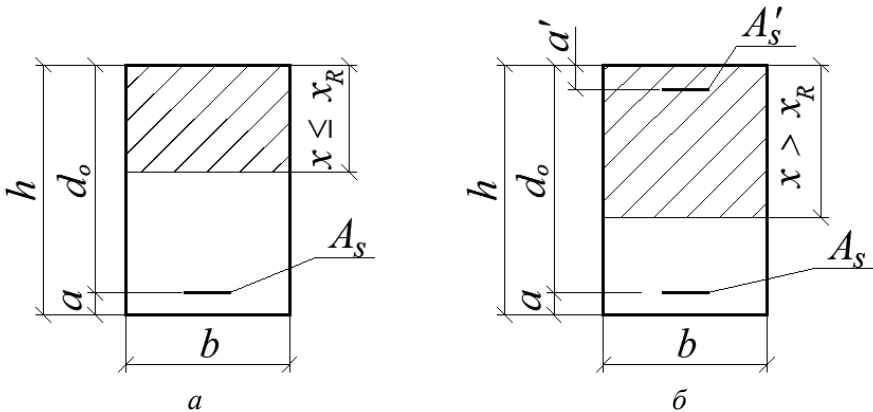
Випадки армування нормальних перерізів згинальних елементів: *a* – з одиничною арматурою; *б* – з подвійною арматурою
